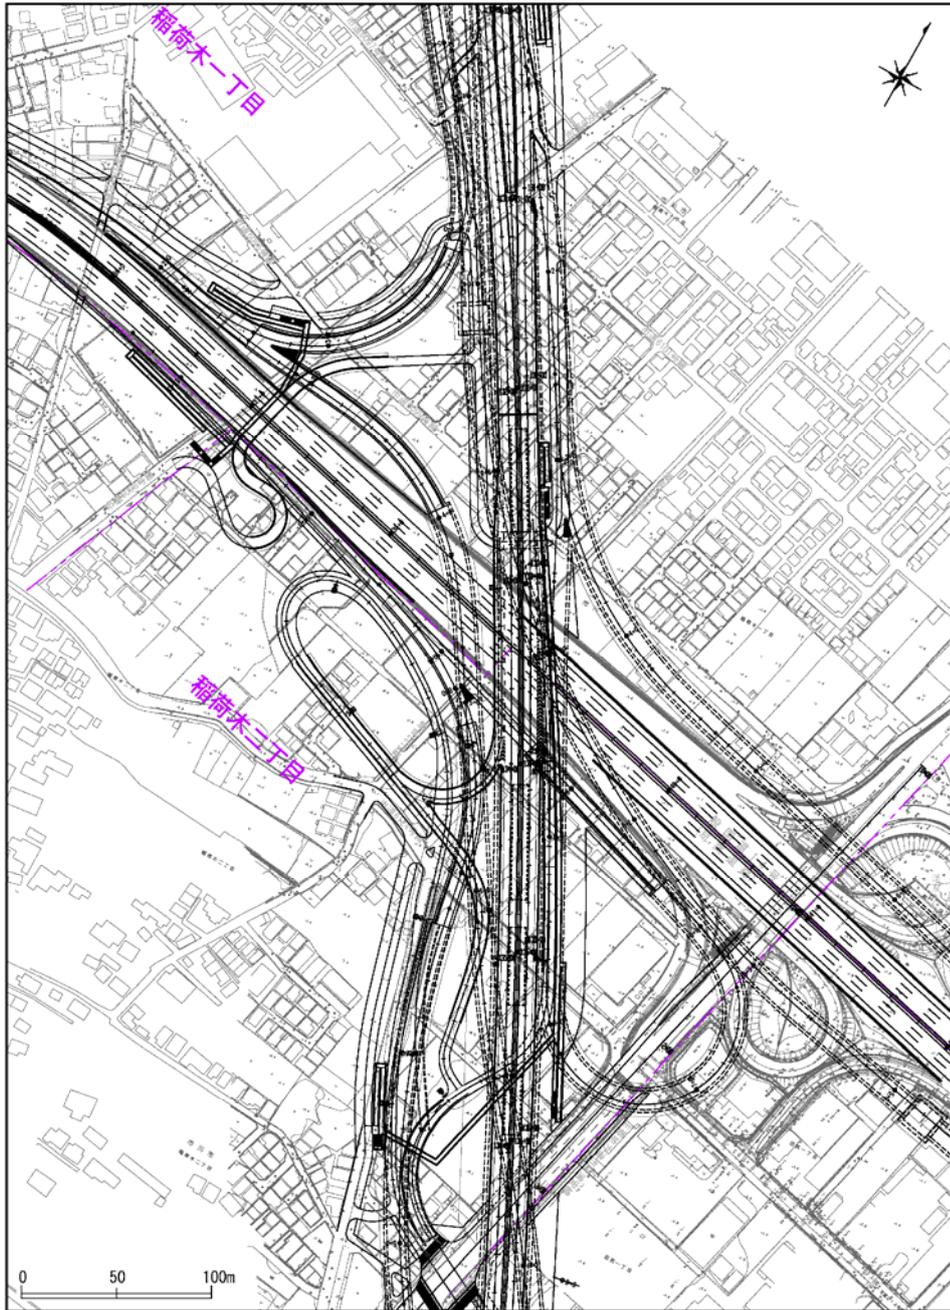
(14) 特殊部予測平面図 (京葉 JCT)
